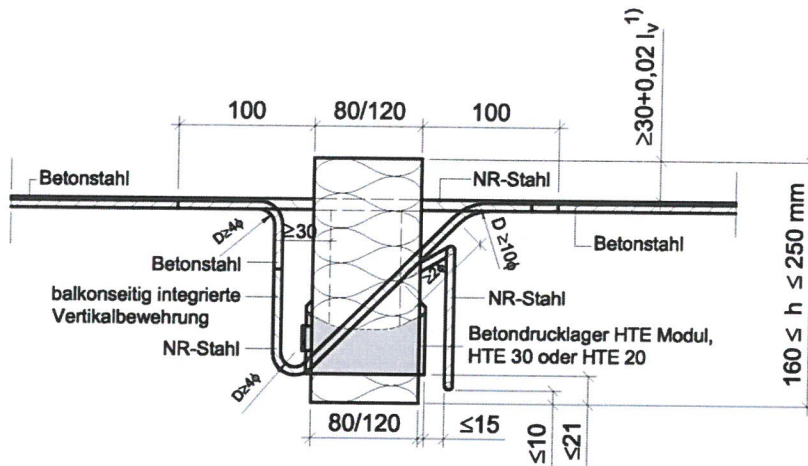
Schöck Isokorb Typ RK-240 mit Sonderbügel
